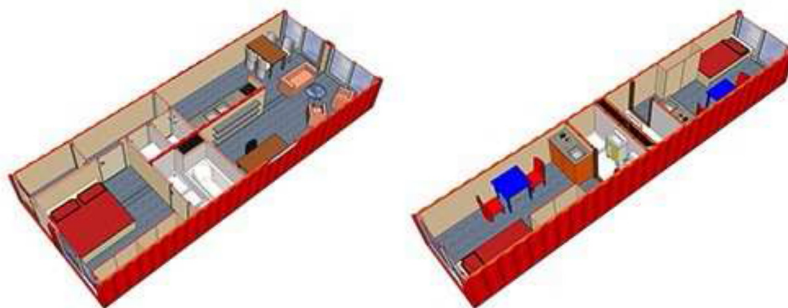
VISTA TRIDIMENSIONAL INTERIOR PROJETO KEETWONEN TEMPOHOUSING
